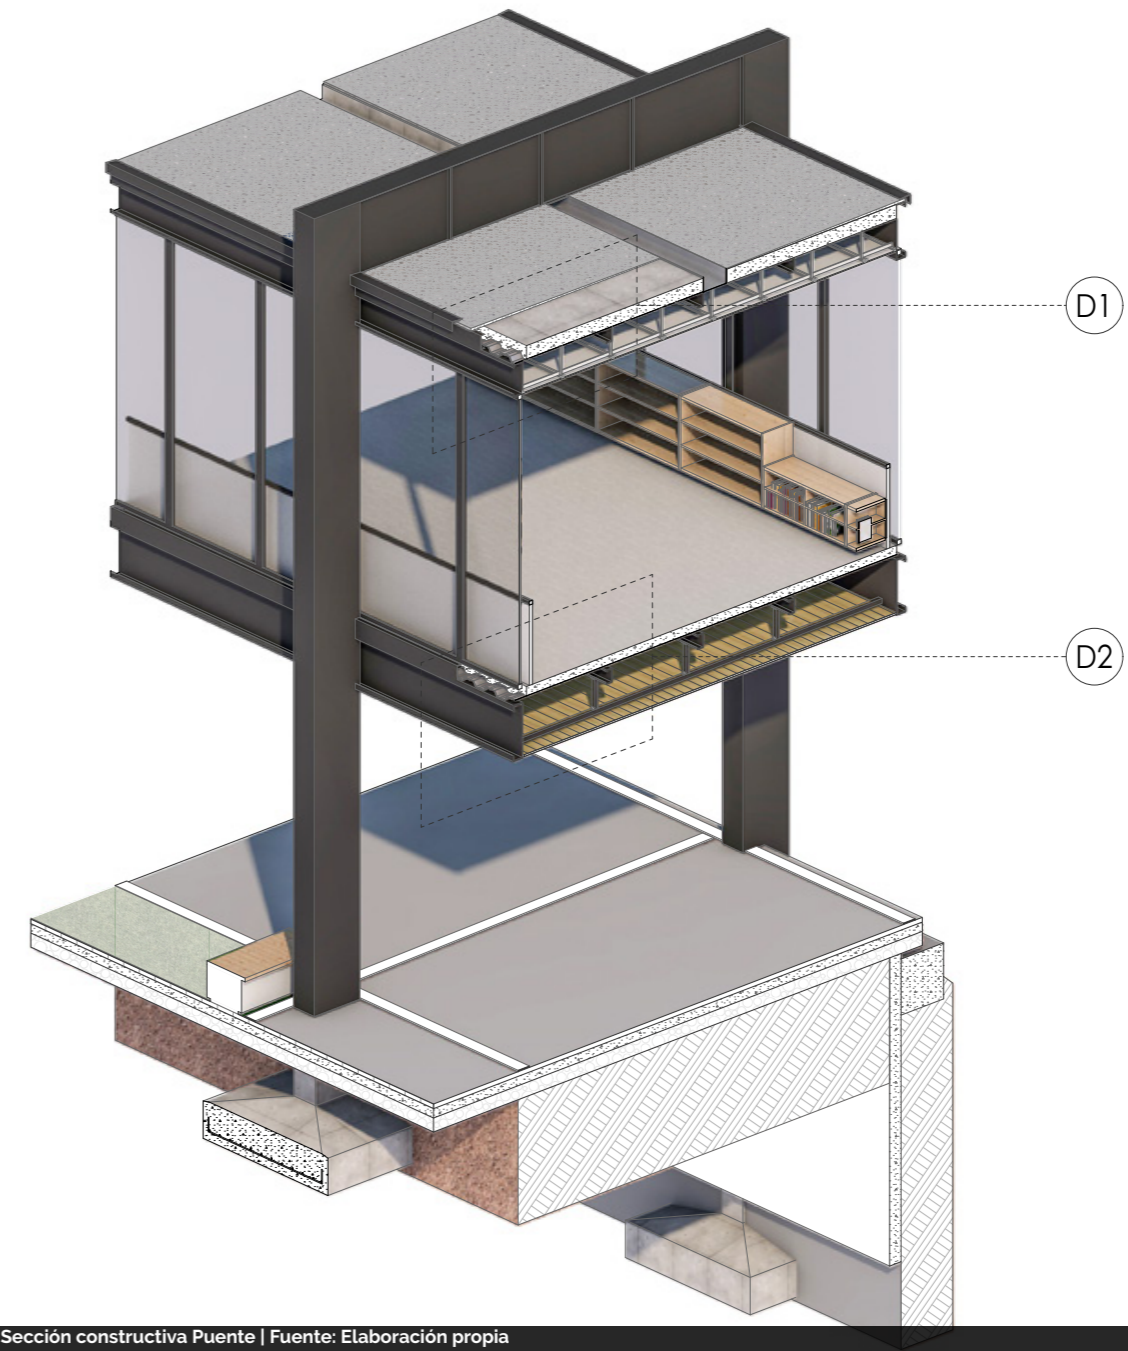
Sección constructiva Puente | Fuente: Elaboración propia
